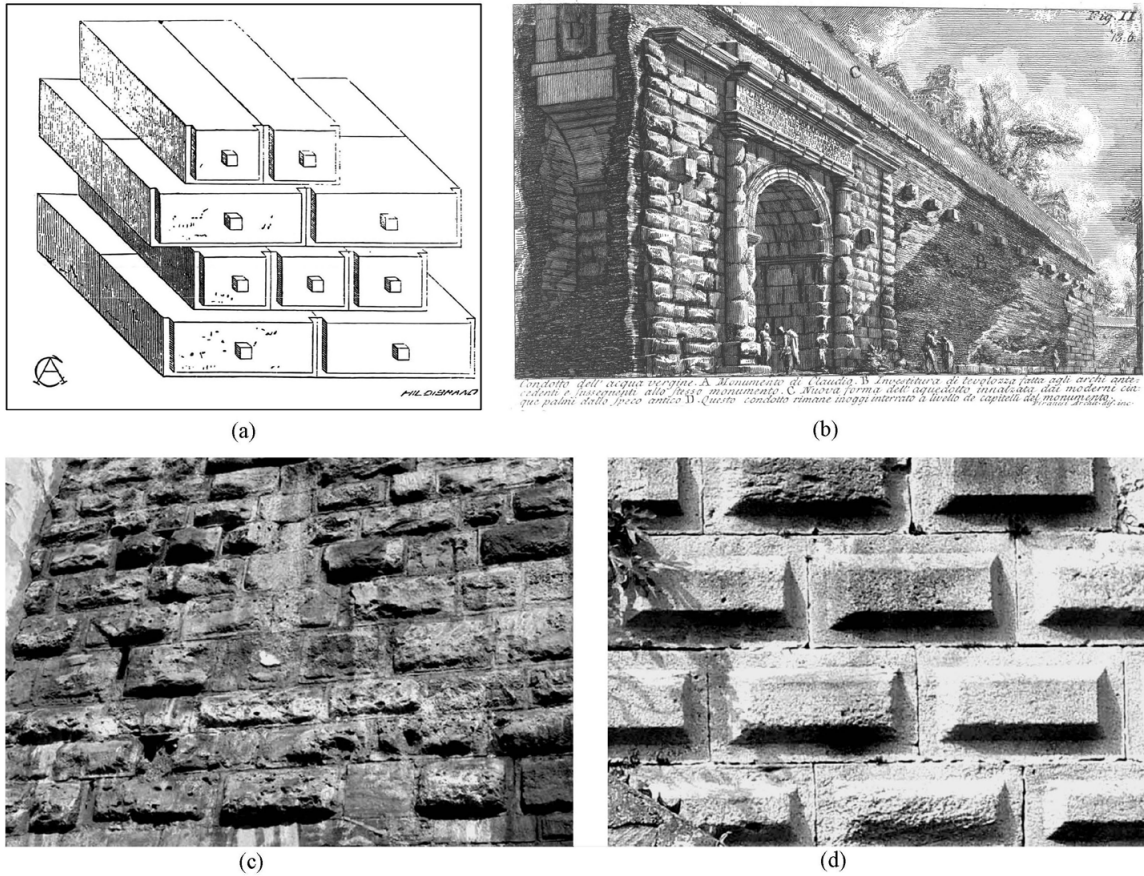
Ejemplos de obras con fachada de piedra con almohadillado. (a) Fortificaciones del Pireo (Choisy 1873). (b) Arco de Claudio (Piranesi 1784). (c) Pottendorf, Baja Austria, primera mitad del siglo XIII (Foto: Th. Danzl). (d) Hainburg, Baja Austria, puerta húngara, ca. 1260. (Foto: Th. Danzl).
